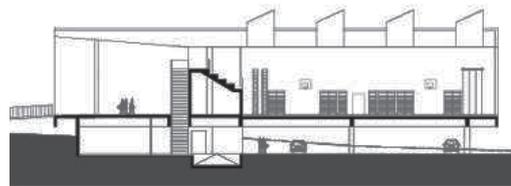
Schnitt - Mehrzweckhalle Kirchdorf
